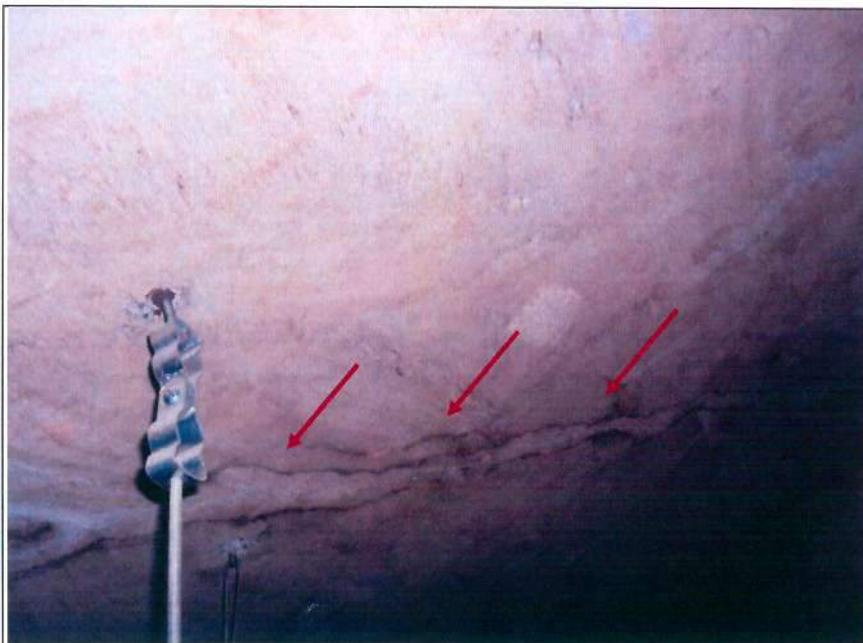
e 10: vista geral da área do forro que encobre a laje do plenário.
